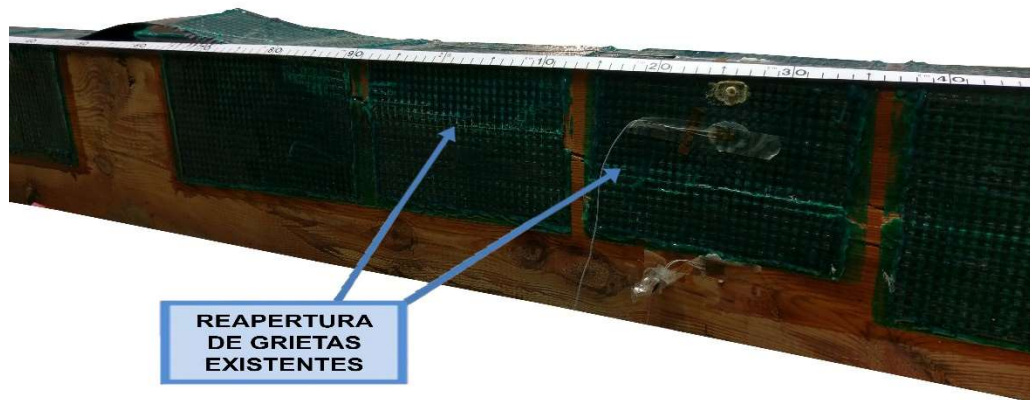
Reapertura de la grieta existente que causó la rotura previa de la viga BR-r-2 antes de volver a ser reforzada.
